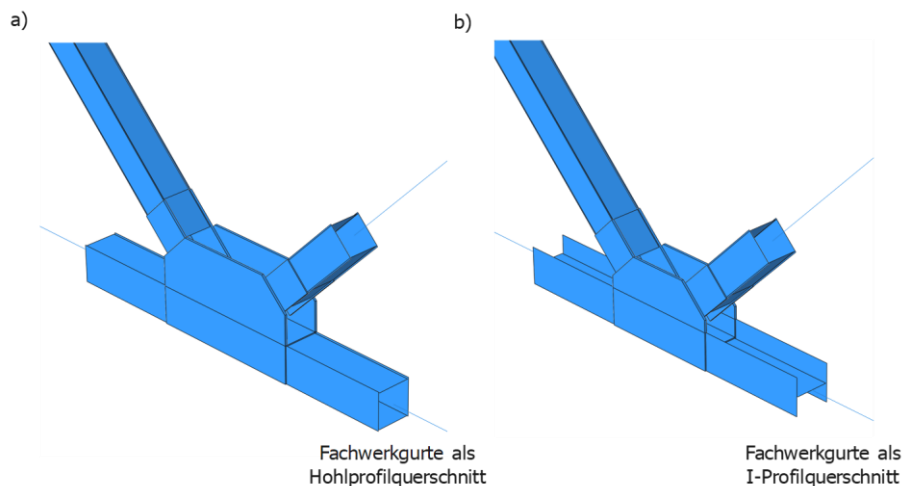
Untersuchte typische Ausführungsformen von Fachwerkdiagonalen und anschließenden Fachwerkknoten: a) Fachwerkgurte als Hohlprofilquerschnitte, b) Fachwerkgurte als liegende I-Profilquerschnitte
